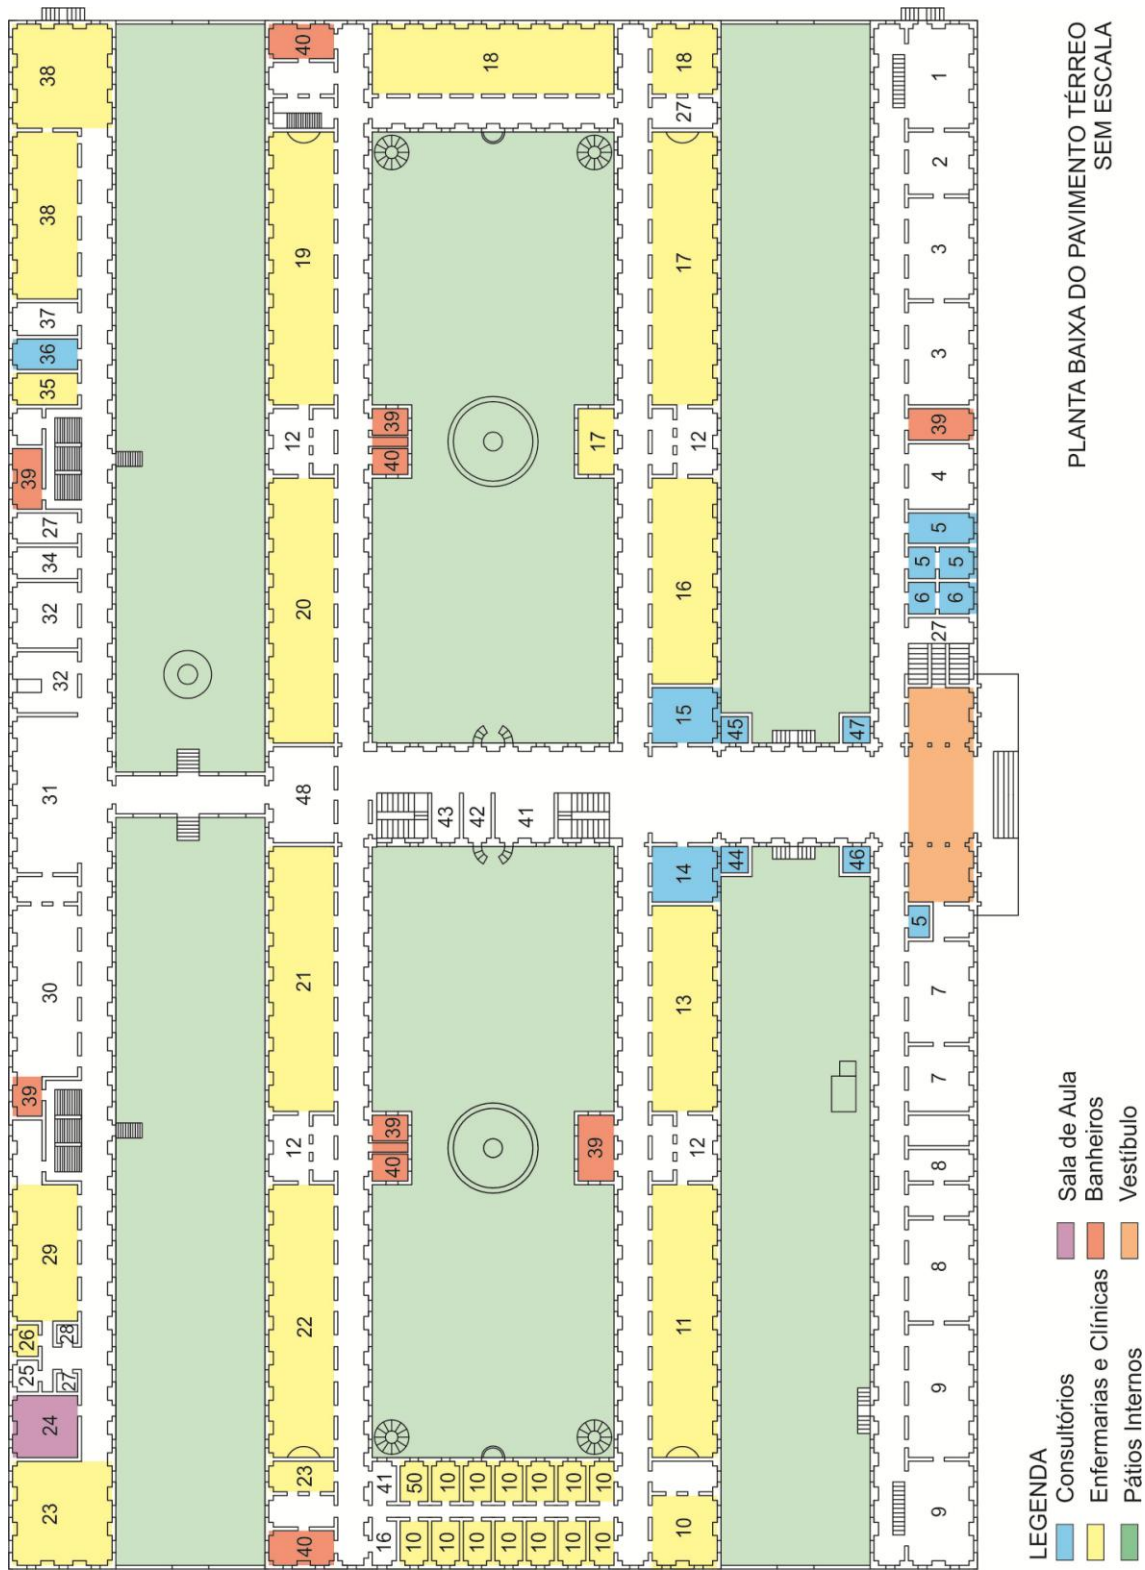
Planta do Hospital da Santa Casa da Misericórdia – Pavimento Térreo. Fonte: Arquivo Central do IPHAN/RJ, 1938, adaptação da Autora, 2014. [Desenho de Fernanda Trindade].
